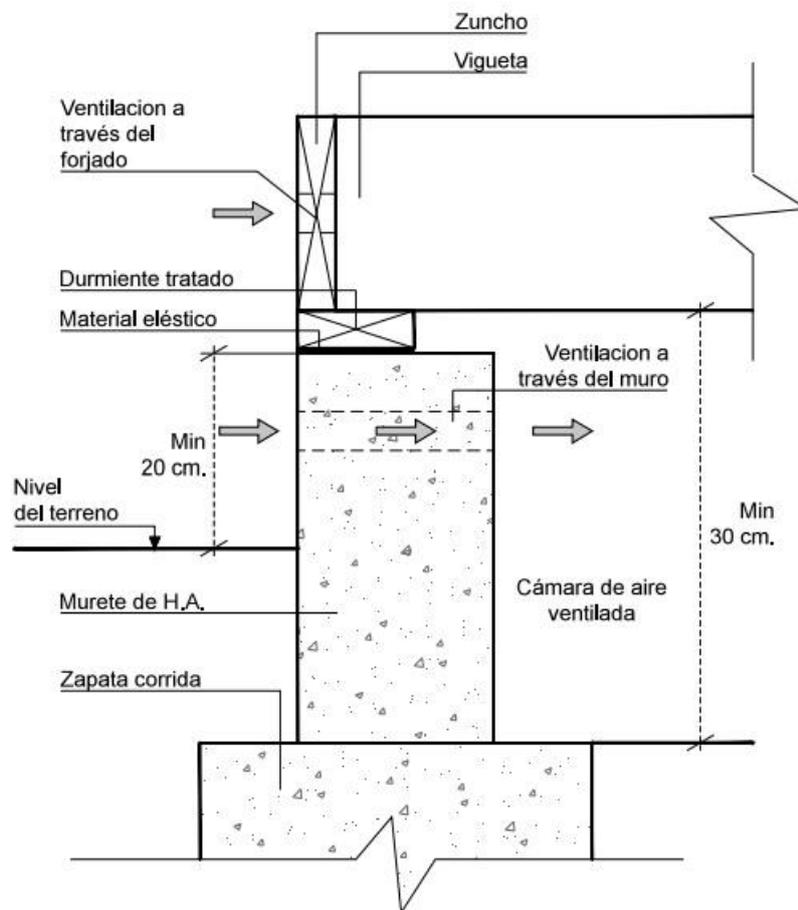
Detalle constructivo de primer forjado sobre una cámara de aire
